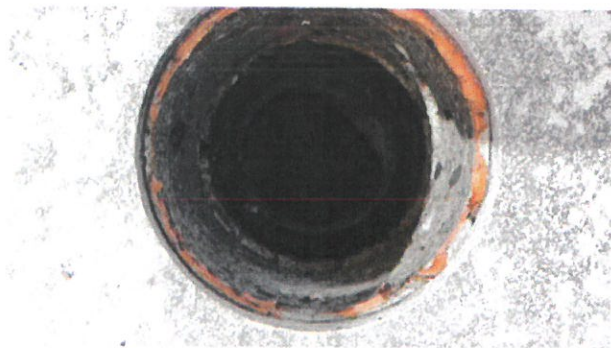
Sekaná sonda SS2 ve stropním prefabrikátu PZD 64-50/530.
